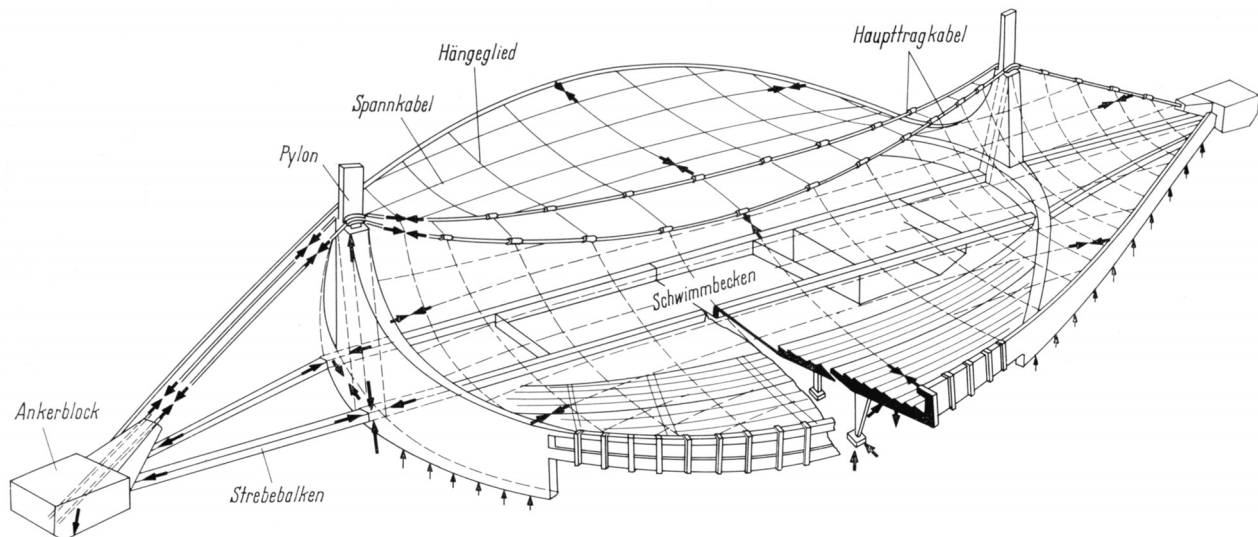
Schema des konstruktiven Systems, 1. Sporthalle Yoyogi, Architekt: Kenzo Tange, Ingenieur: Yoshikatsu Tsuboi (BNr. 98) [Tsuboi 1966]
